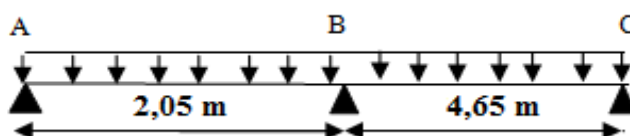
Schéma statique de la poutrelle T2 (plancher terrasse inaccessible)
